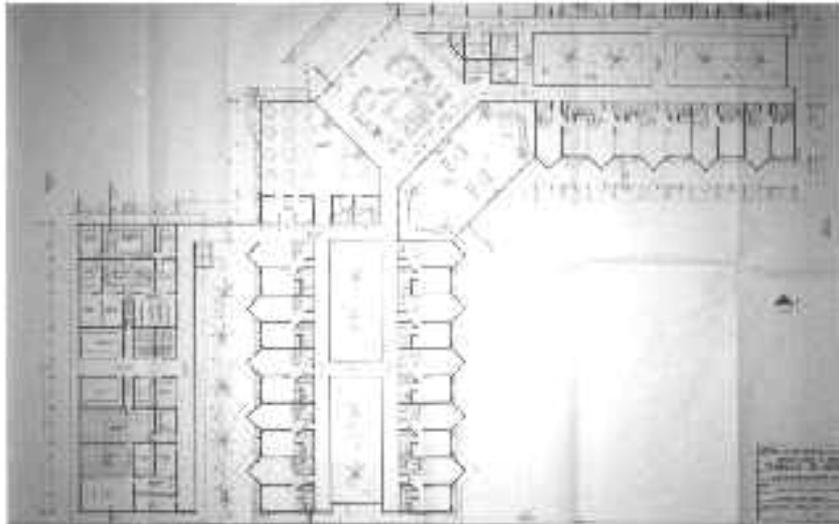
Planta baixa de um projeto com soluções tipicamente modernas
